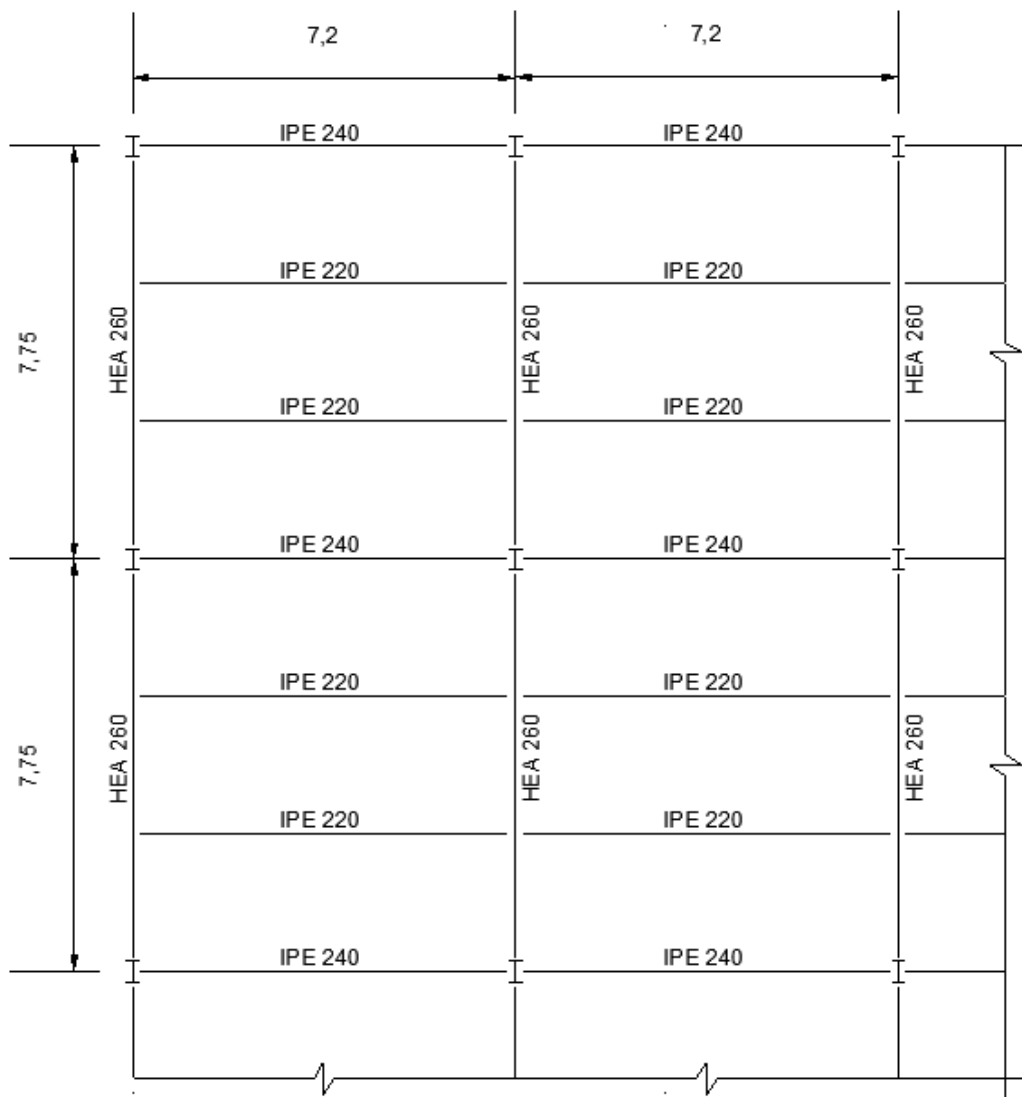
Disposição geral da estrutura metálica ao nível do pavimento.
